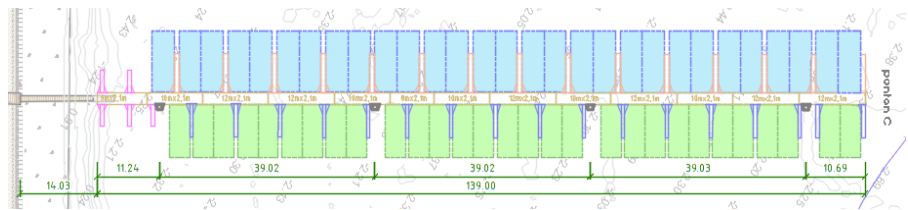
Vue en plan de la panne C – Extrait du plan NAC 24009 PLA PRO CPT 0102 B
